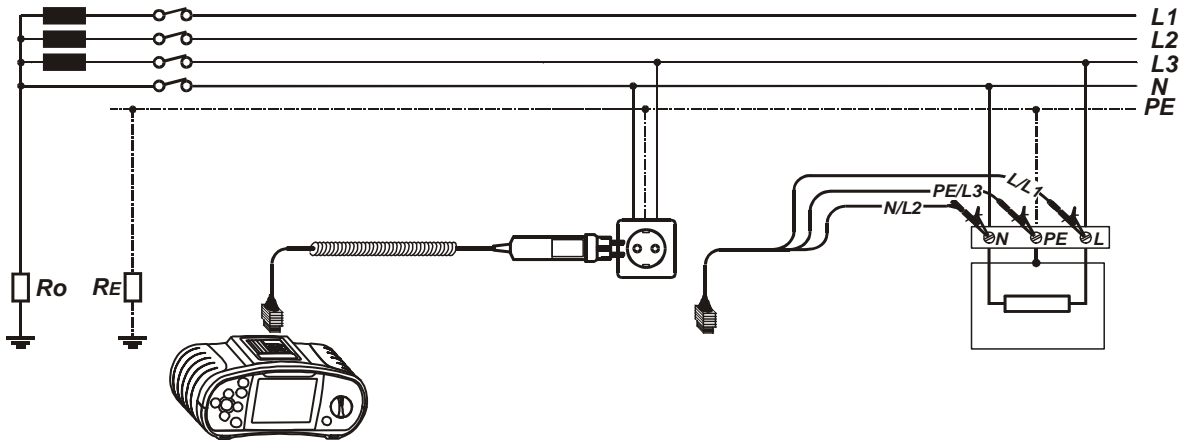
Conexión de la clavija del cable y el cable de prueba universal
